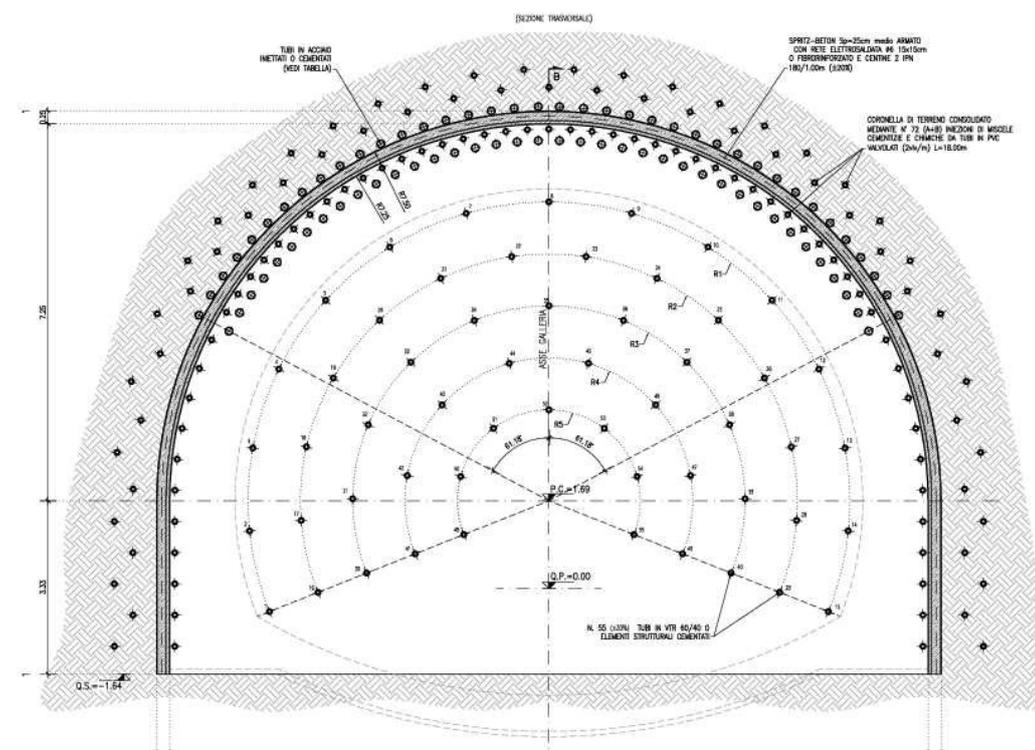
Sezione di scavo tipo C2JTG – Sezione trasversale
